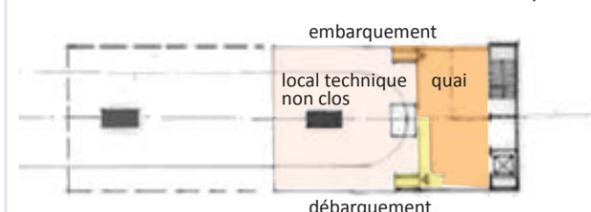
PLAN DE LA STATION MONTMORENCY (NIVEAU RDC+3)
